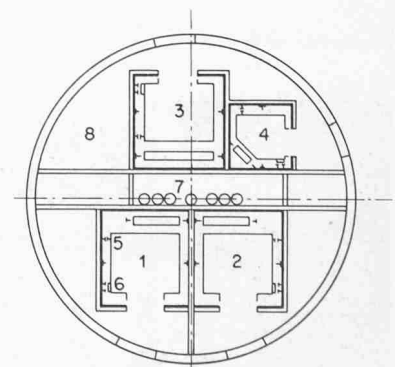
Grundriss des Fernsehturmes, schematisch
